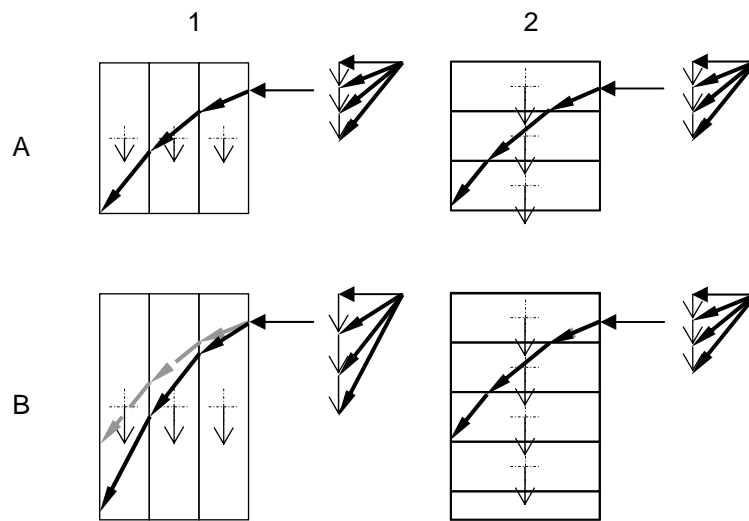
Estribo sometido a su peso propio y a un empuje horizontal en cabeza. Cálculos de línea de presiones para dos estribos A y B de distinta altura, utilizando secciones verticales (1) y horizontales (2).
